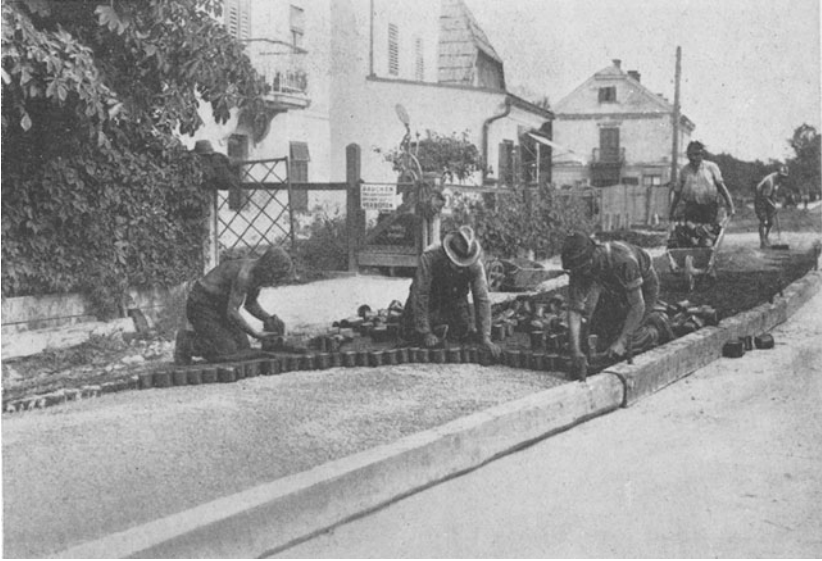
Salzbundesstraße in Mautern im Liesingtal (Steiermark); Rundholzstöckelbelag, halbseitiger Einbau der schutzbehandelten Stöckel (ausgeführt von der Baubezirksleitung Bruck a. M. 1934)
